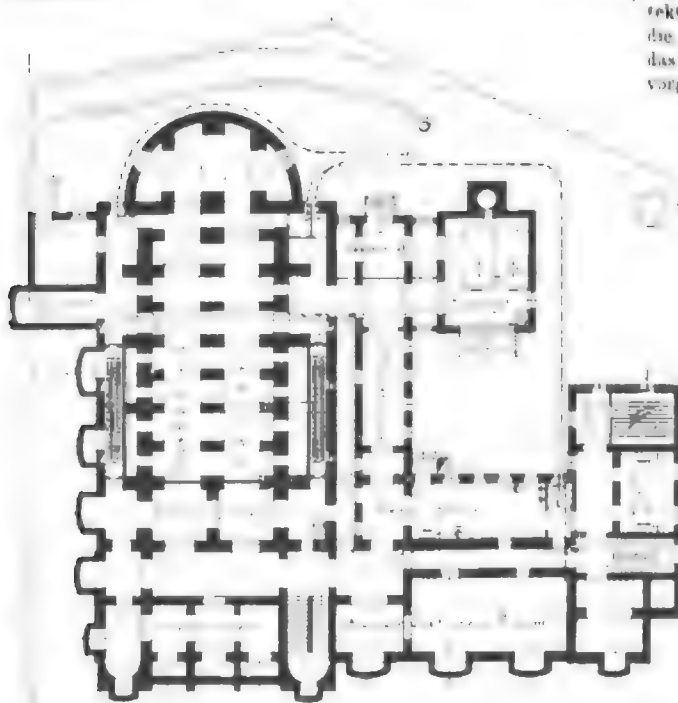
Souterrain Grundriss. 1:500.
